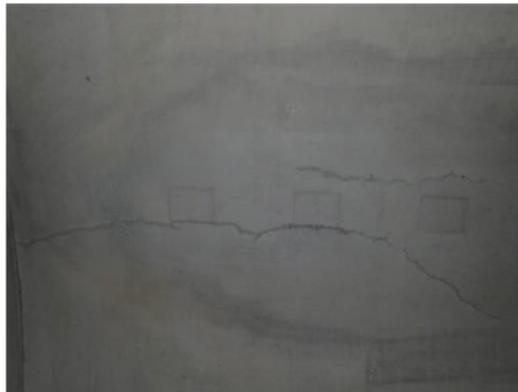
E トンネルの天端部の縦断方向のひび割れ事例
